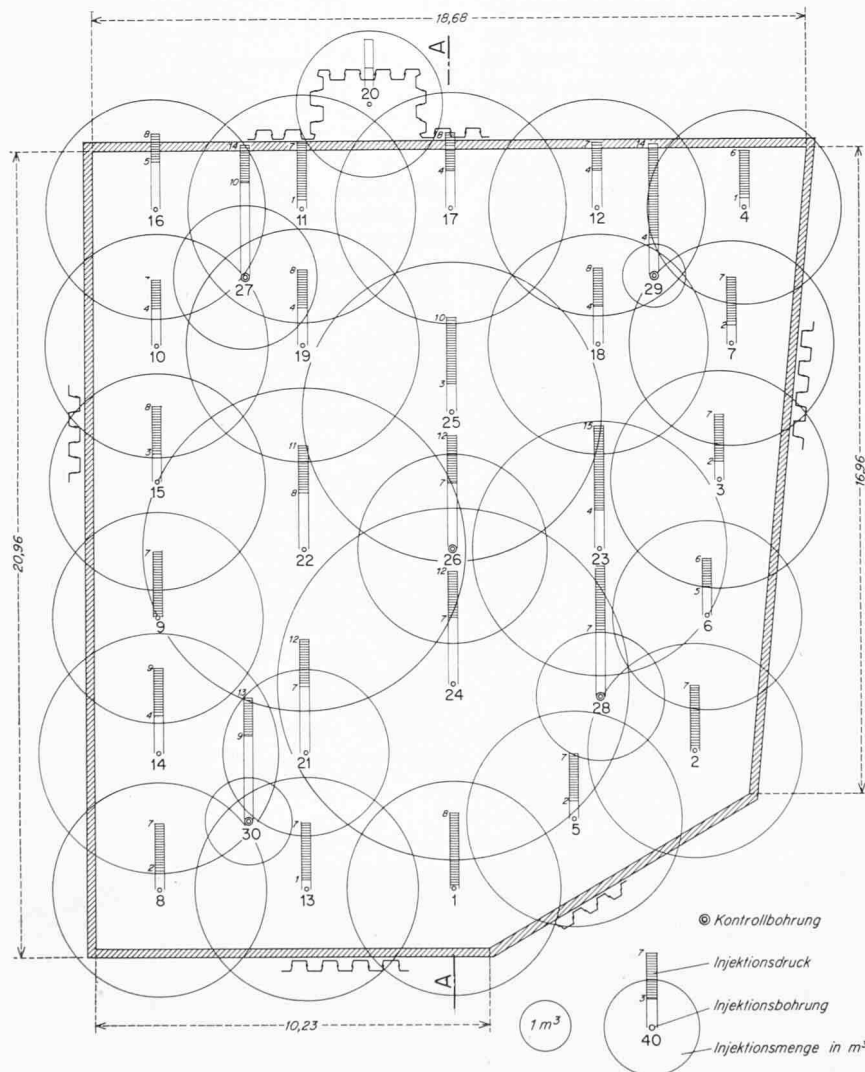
Injektionswanne Lagerhaus Kuoni in Zürich (Swissboring). Grundriss 1:200
